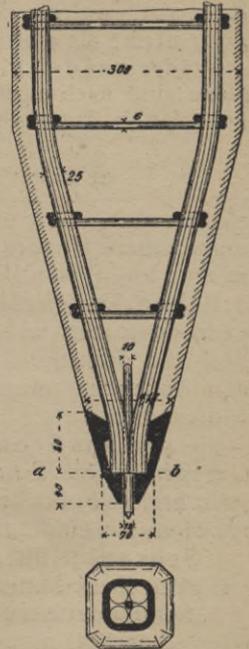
Eiserner Schuh für Eisenbetonpfähle.
